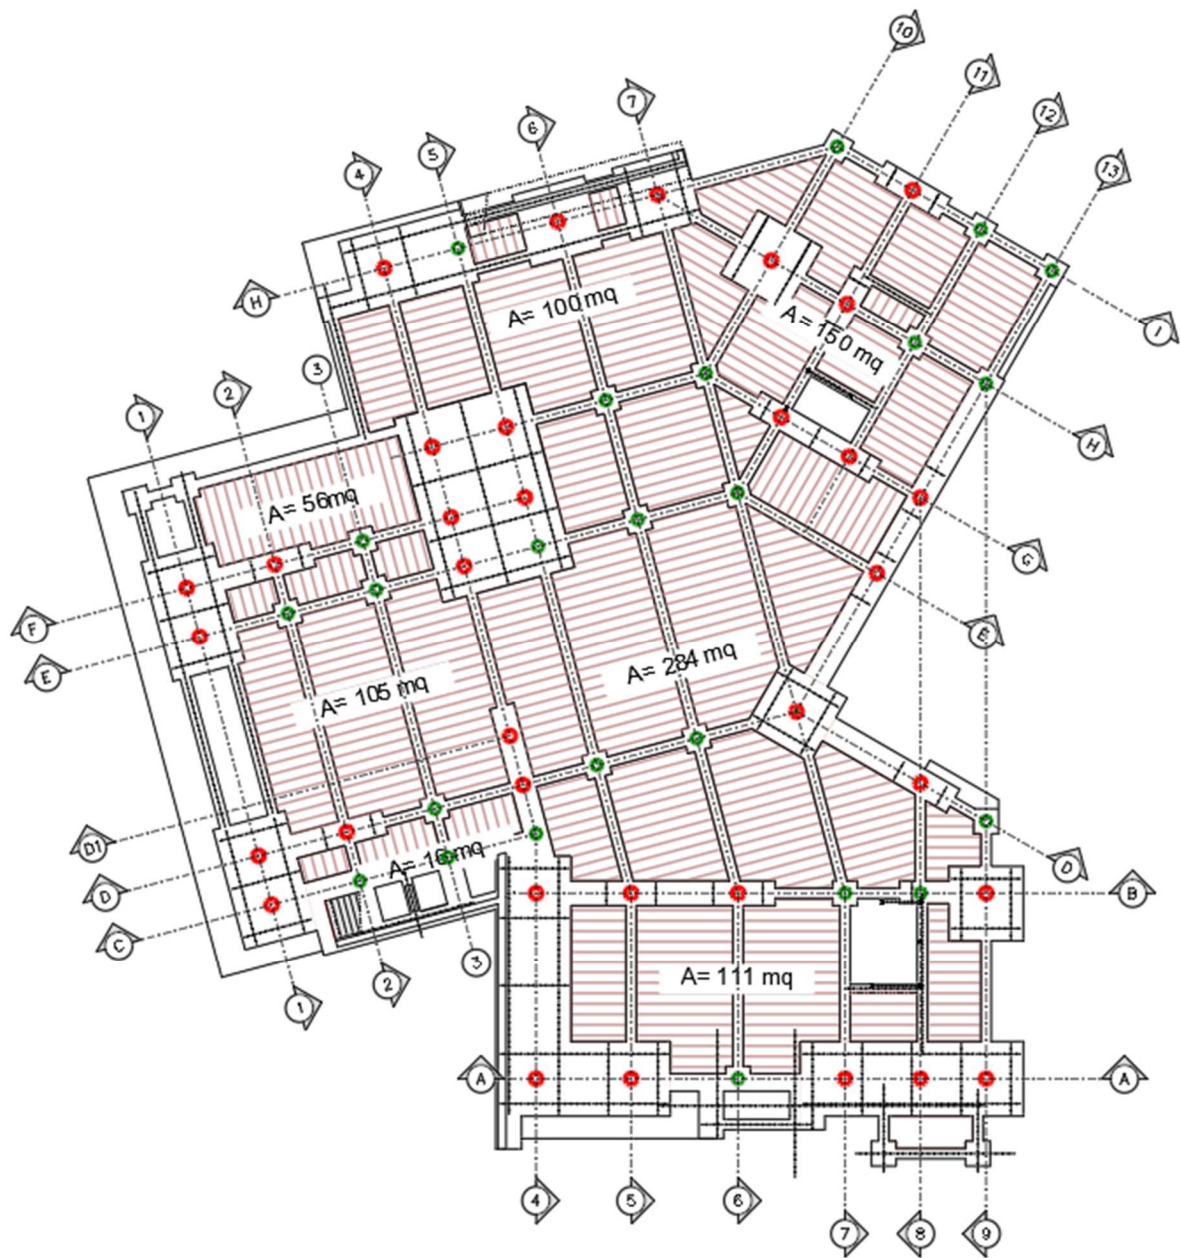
Piano fondazione: calcolo aree solaio con predalle
